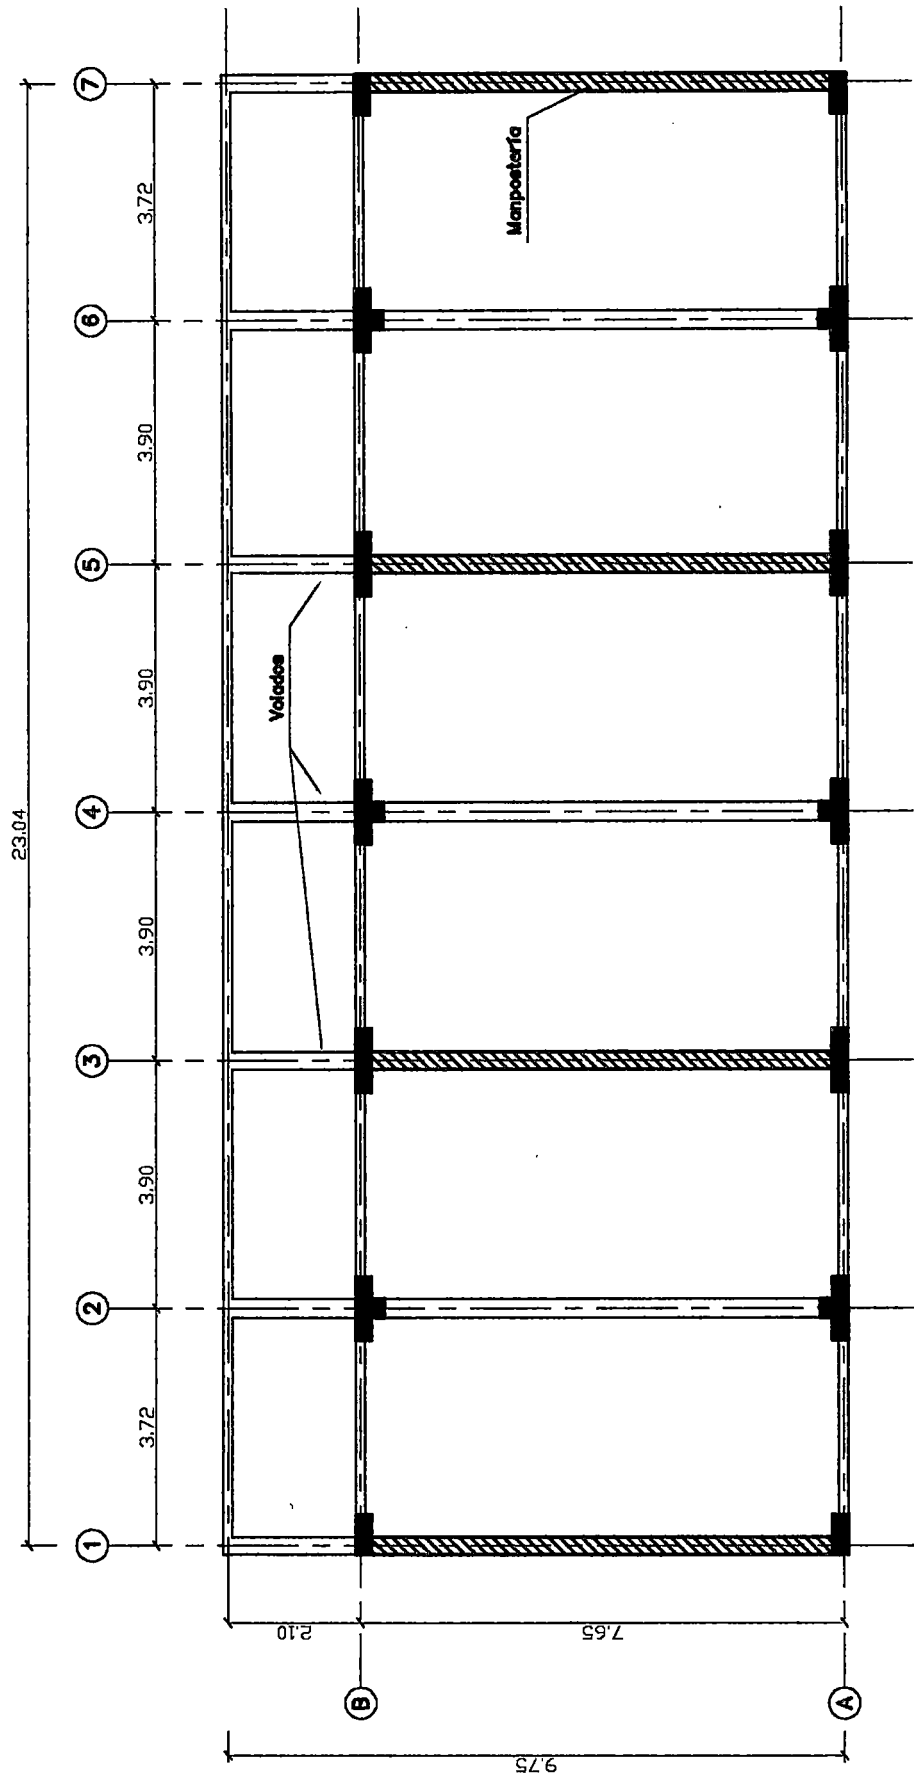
COLEGIO— PLANTA TÍPICA
